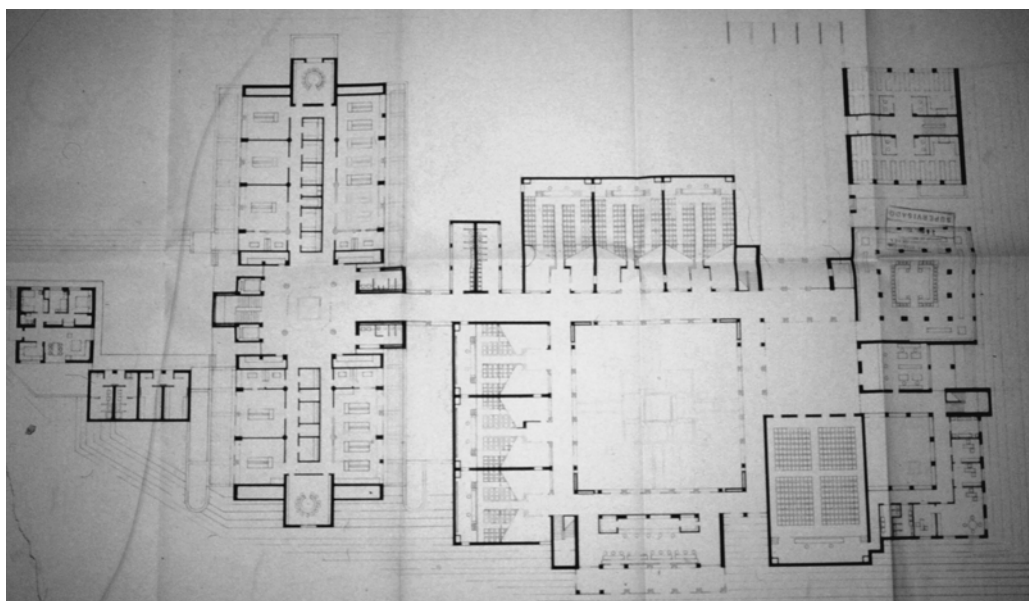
Facultad de Farmacia: planta general, por Julio Cano Lasso e Ignacio Mendaro Corsini, enero 1978.
